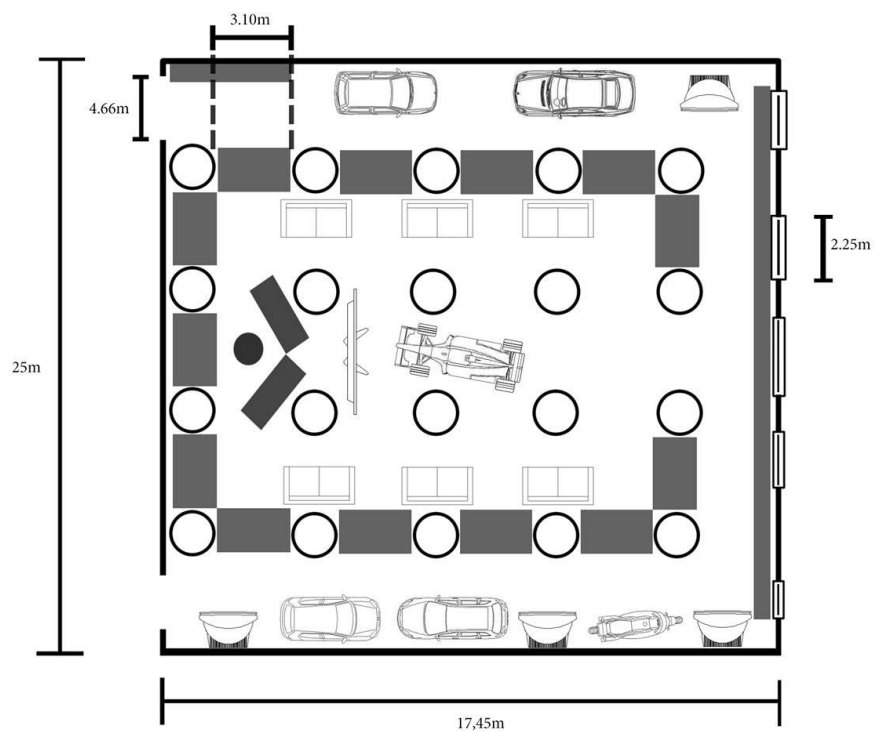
Planta para a Exposição – Ana Raquel Monteiro ©
